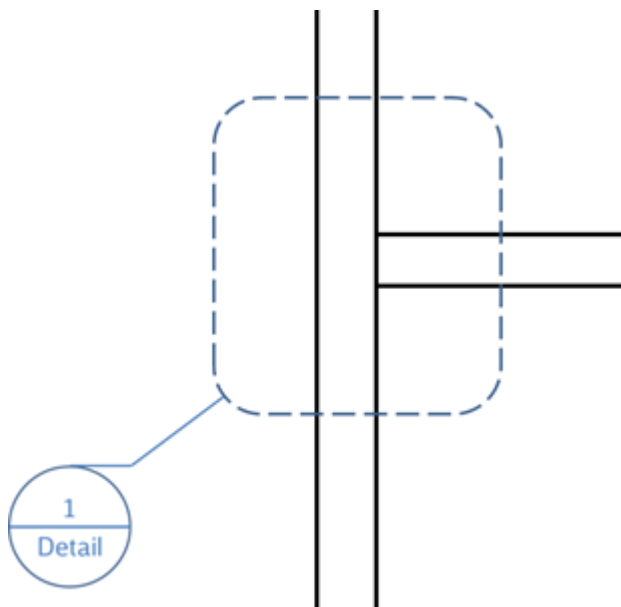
Verweis auf Detail 1 im Grundriss/Schnitt
